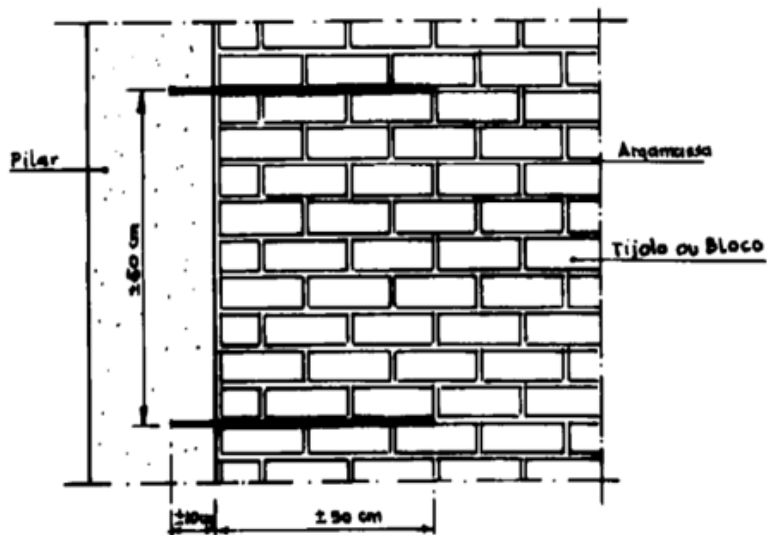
Ligação da alvenaria ao pilar com gancho em aço com dois ramos
